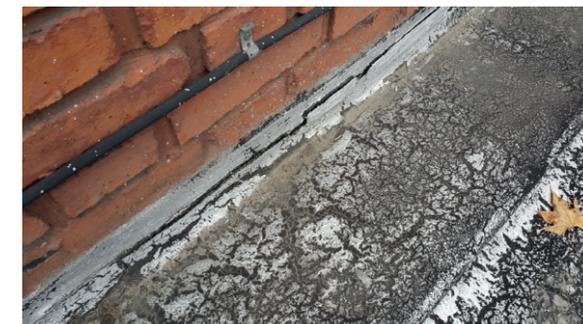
Membrana asfáltica fisurada y pérdida de adhesión con muro
